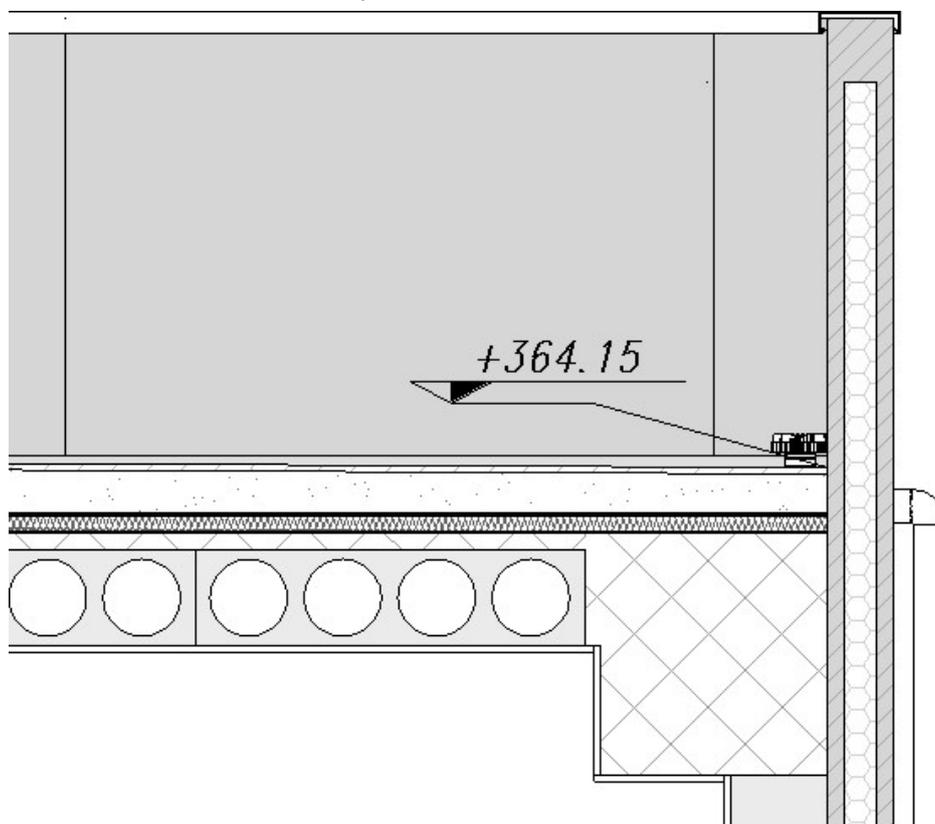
Particolare solaio alveolare e pannello esterno
